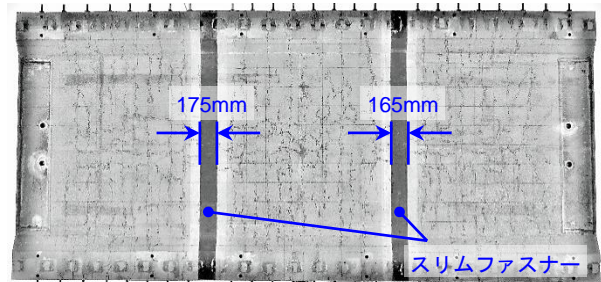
床版下面のひび割れ(載荷終了時)
